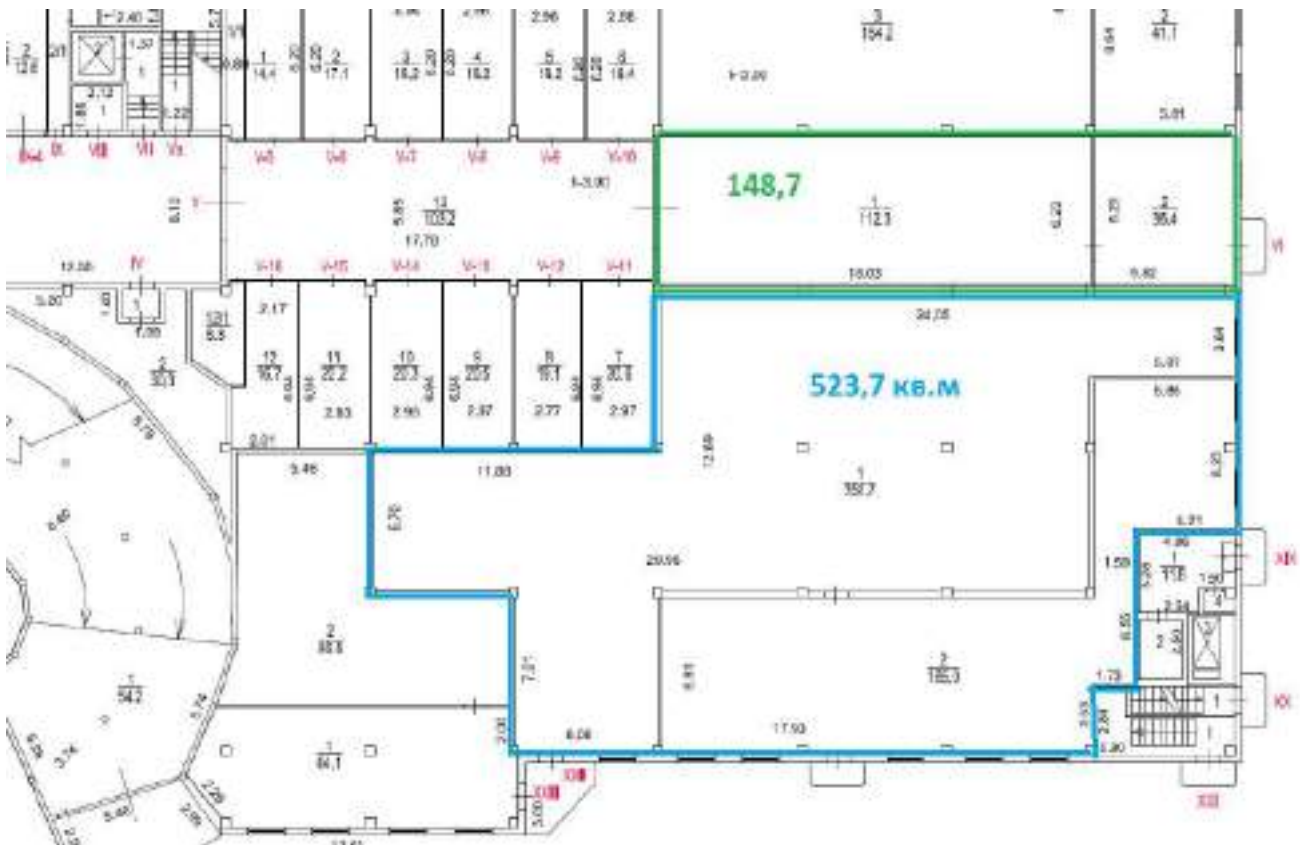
Схема оцениваемых помещений на плане этажа №1
